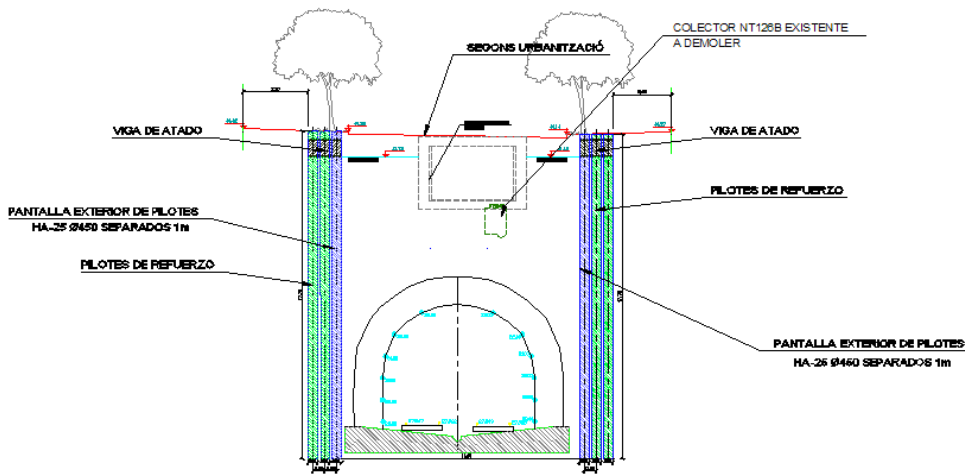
Sección tipo. Fase 3 ejecución de viga de atado
